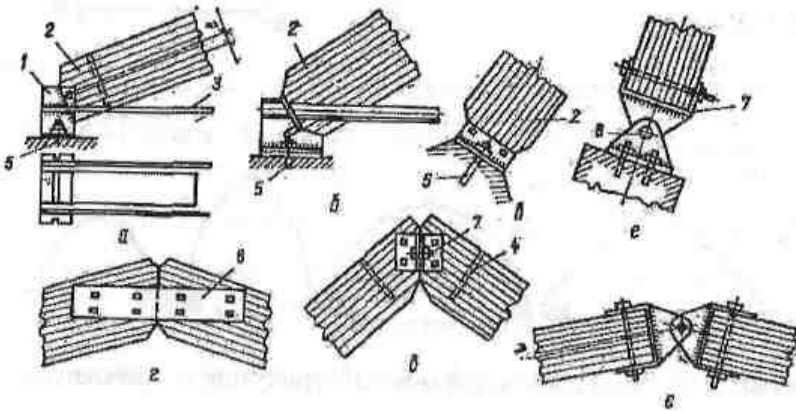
Вузли сегментних тришарнірних арок: а...д – для прольотів до 30 м; е, е' – те саме, понад 30 м; 1 – сталевий зварний башмак; 2 – арка; 3 – затяжка; 4 – вклеєні стрижні; 5 – анкери; 6 – накладки; 7 – сталевий башмак; 8 – шарнір
